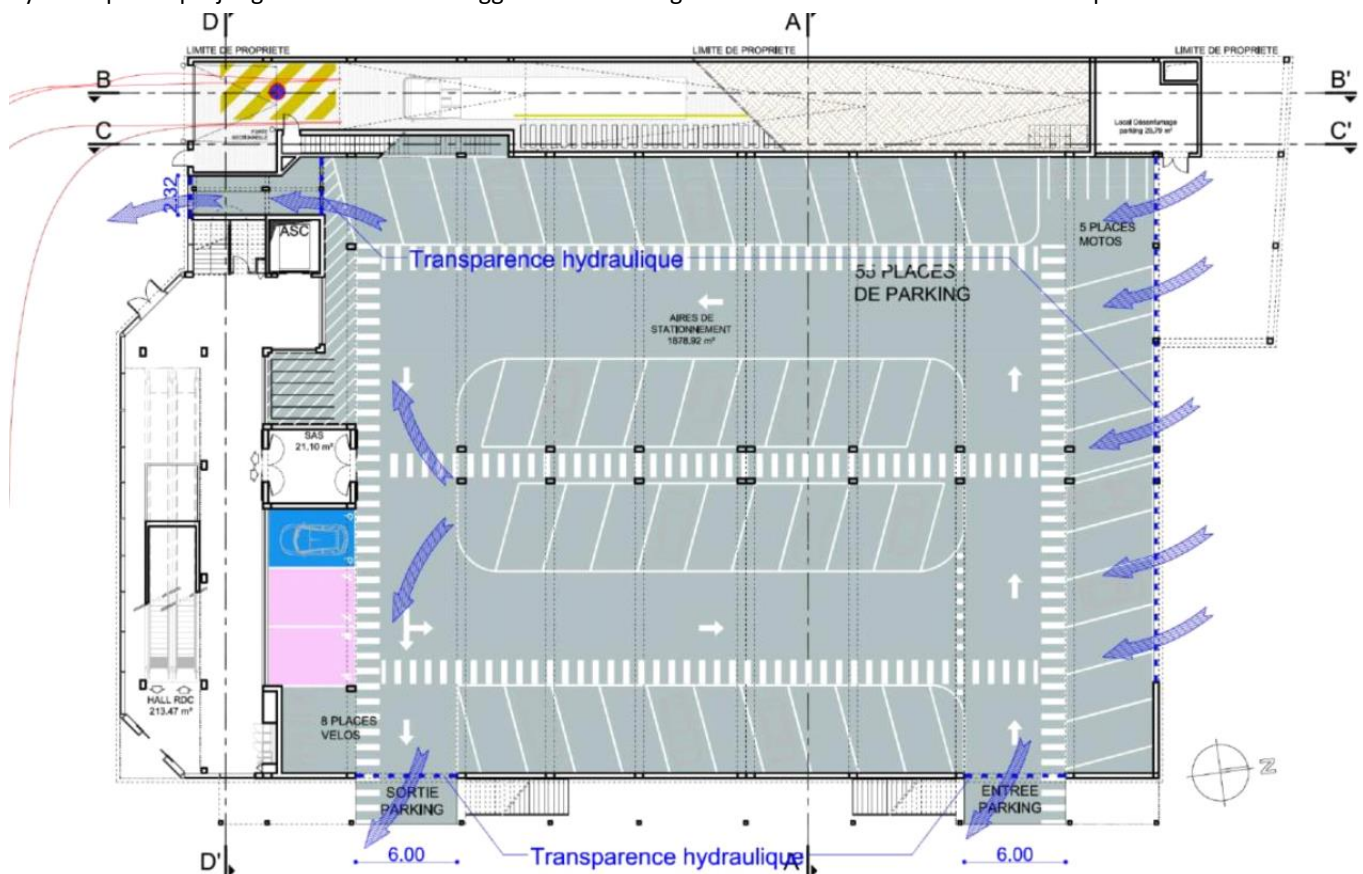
Vue en plan du rez-de-chaussée du bâtiment et zones de transparences hydrauliques (source : Étude hydraulique Mai 2021 – Cereq)
